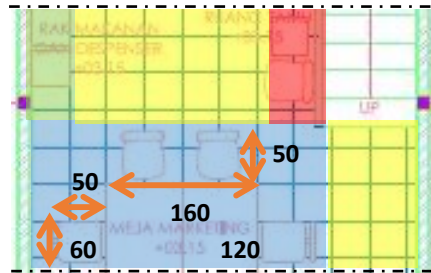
Ruang Kerja Lantai 1 Objek B
